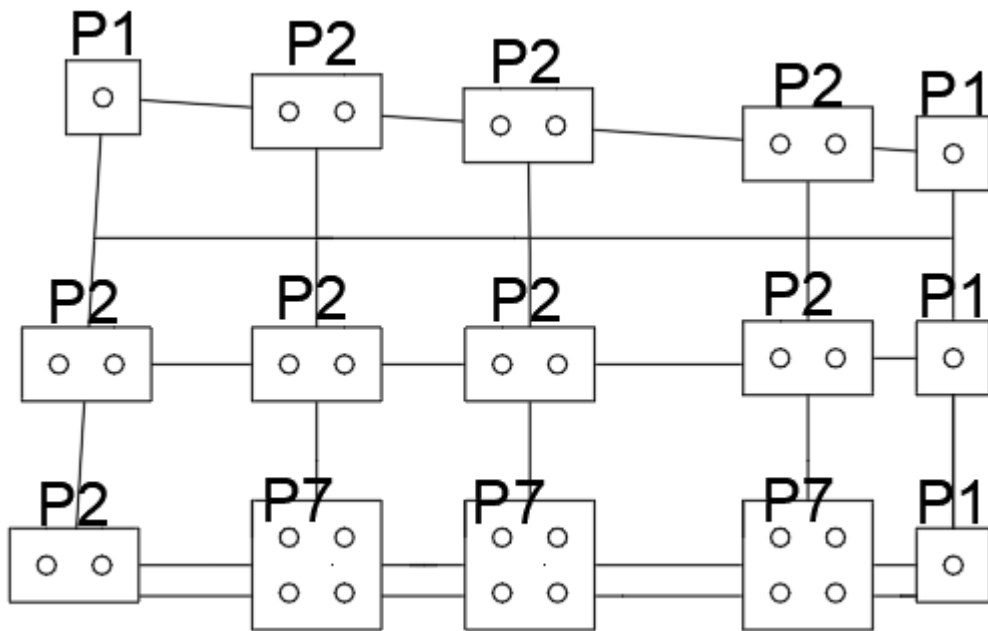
Denah *Final* Pondasi Bangunan B.2
